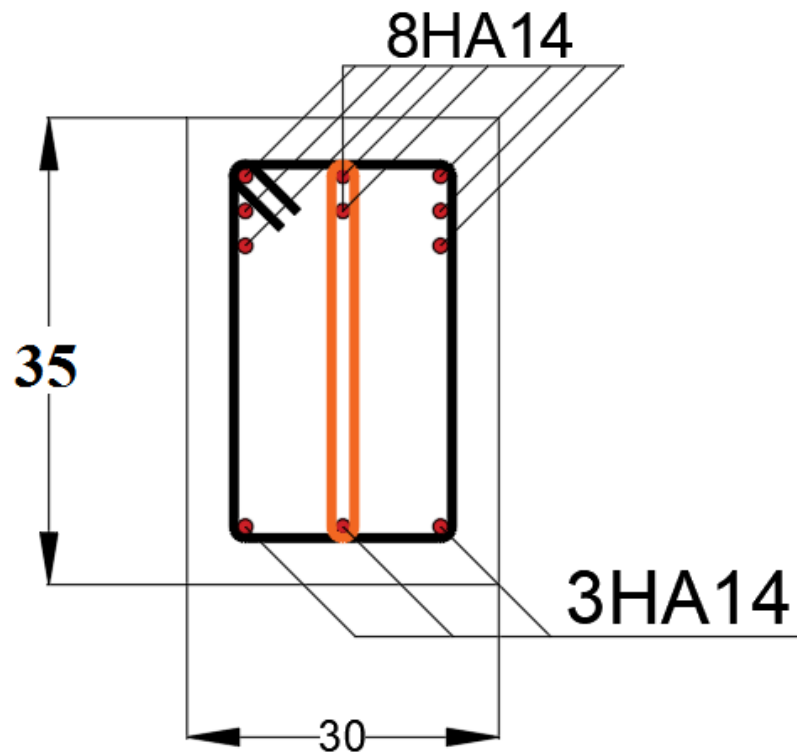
Schéma de ferrailage de la poutre principale (Appuis)
